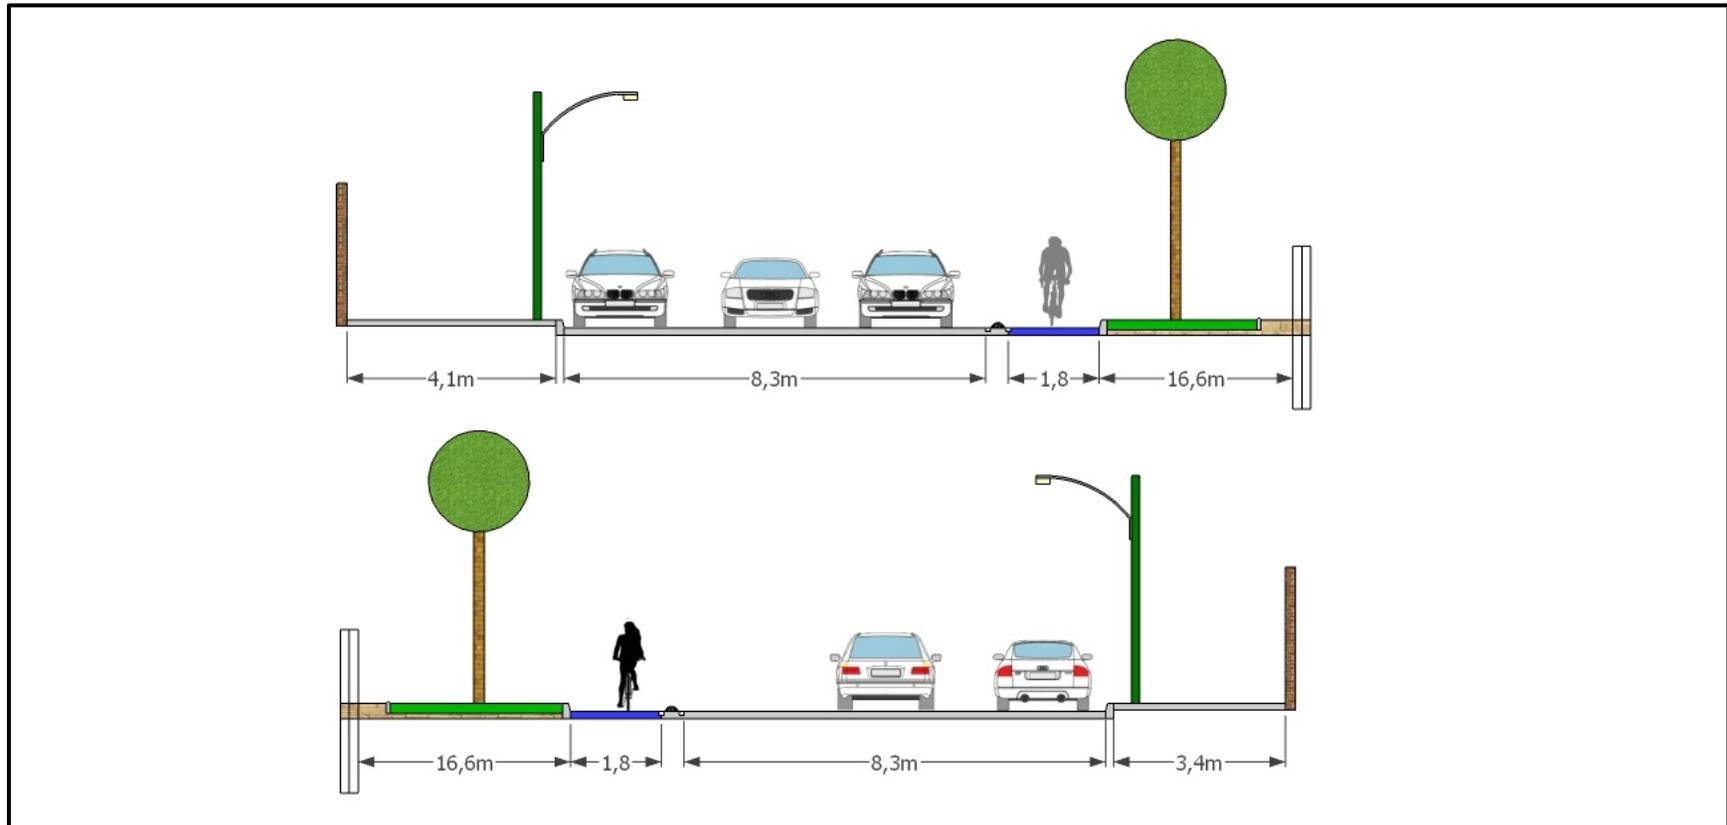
Nuevo Perfil Transversal Eje B (Acceso VTP) – Ancho calzada mínimo y máximo
